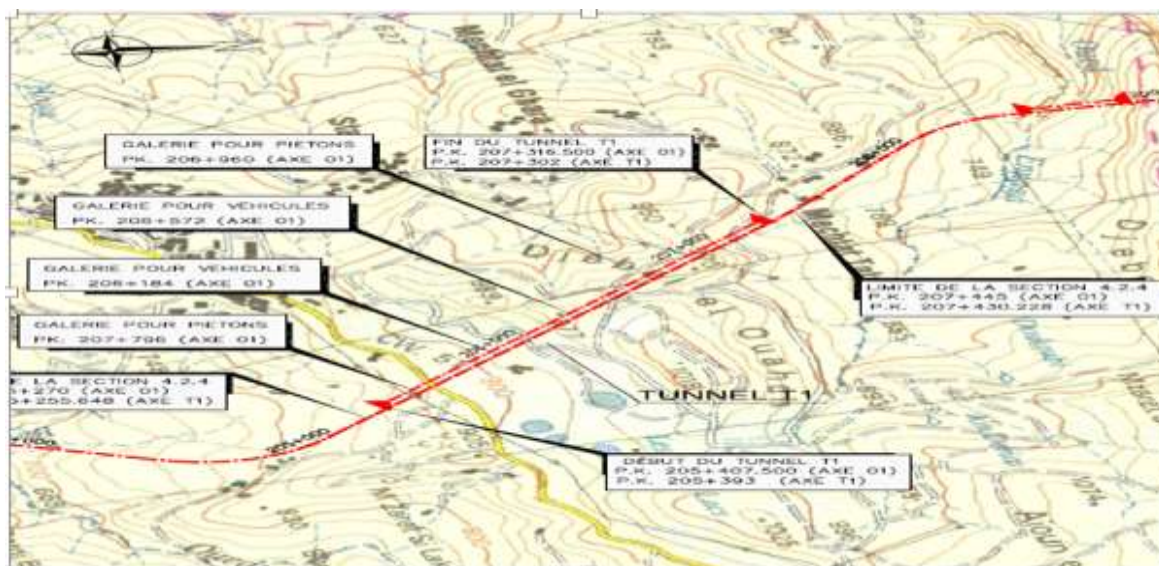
Tracé en plan du Tunnel T1 (document de projet)
